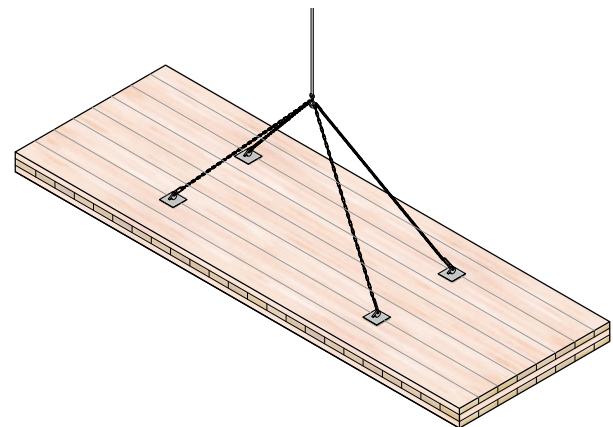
Conjunto de cadenas unidas a anclajes de elevación.
